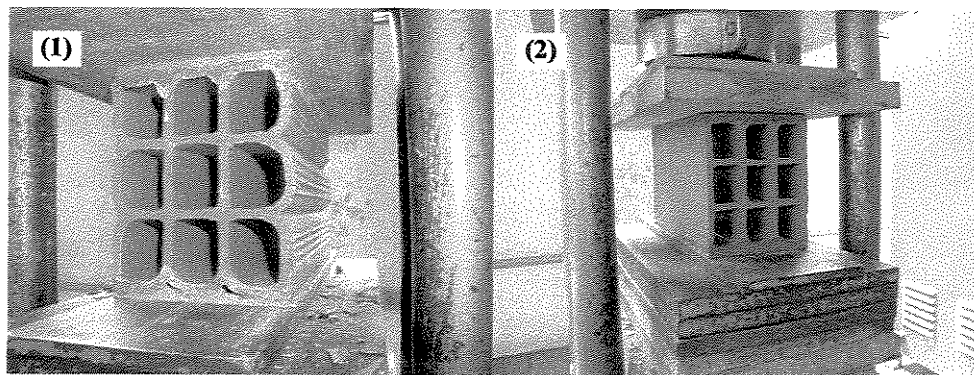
(1) Bloco moldado com paredes curvas; (2) Bloco moldado com paredes retas.
